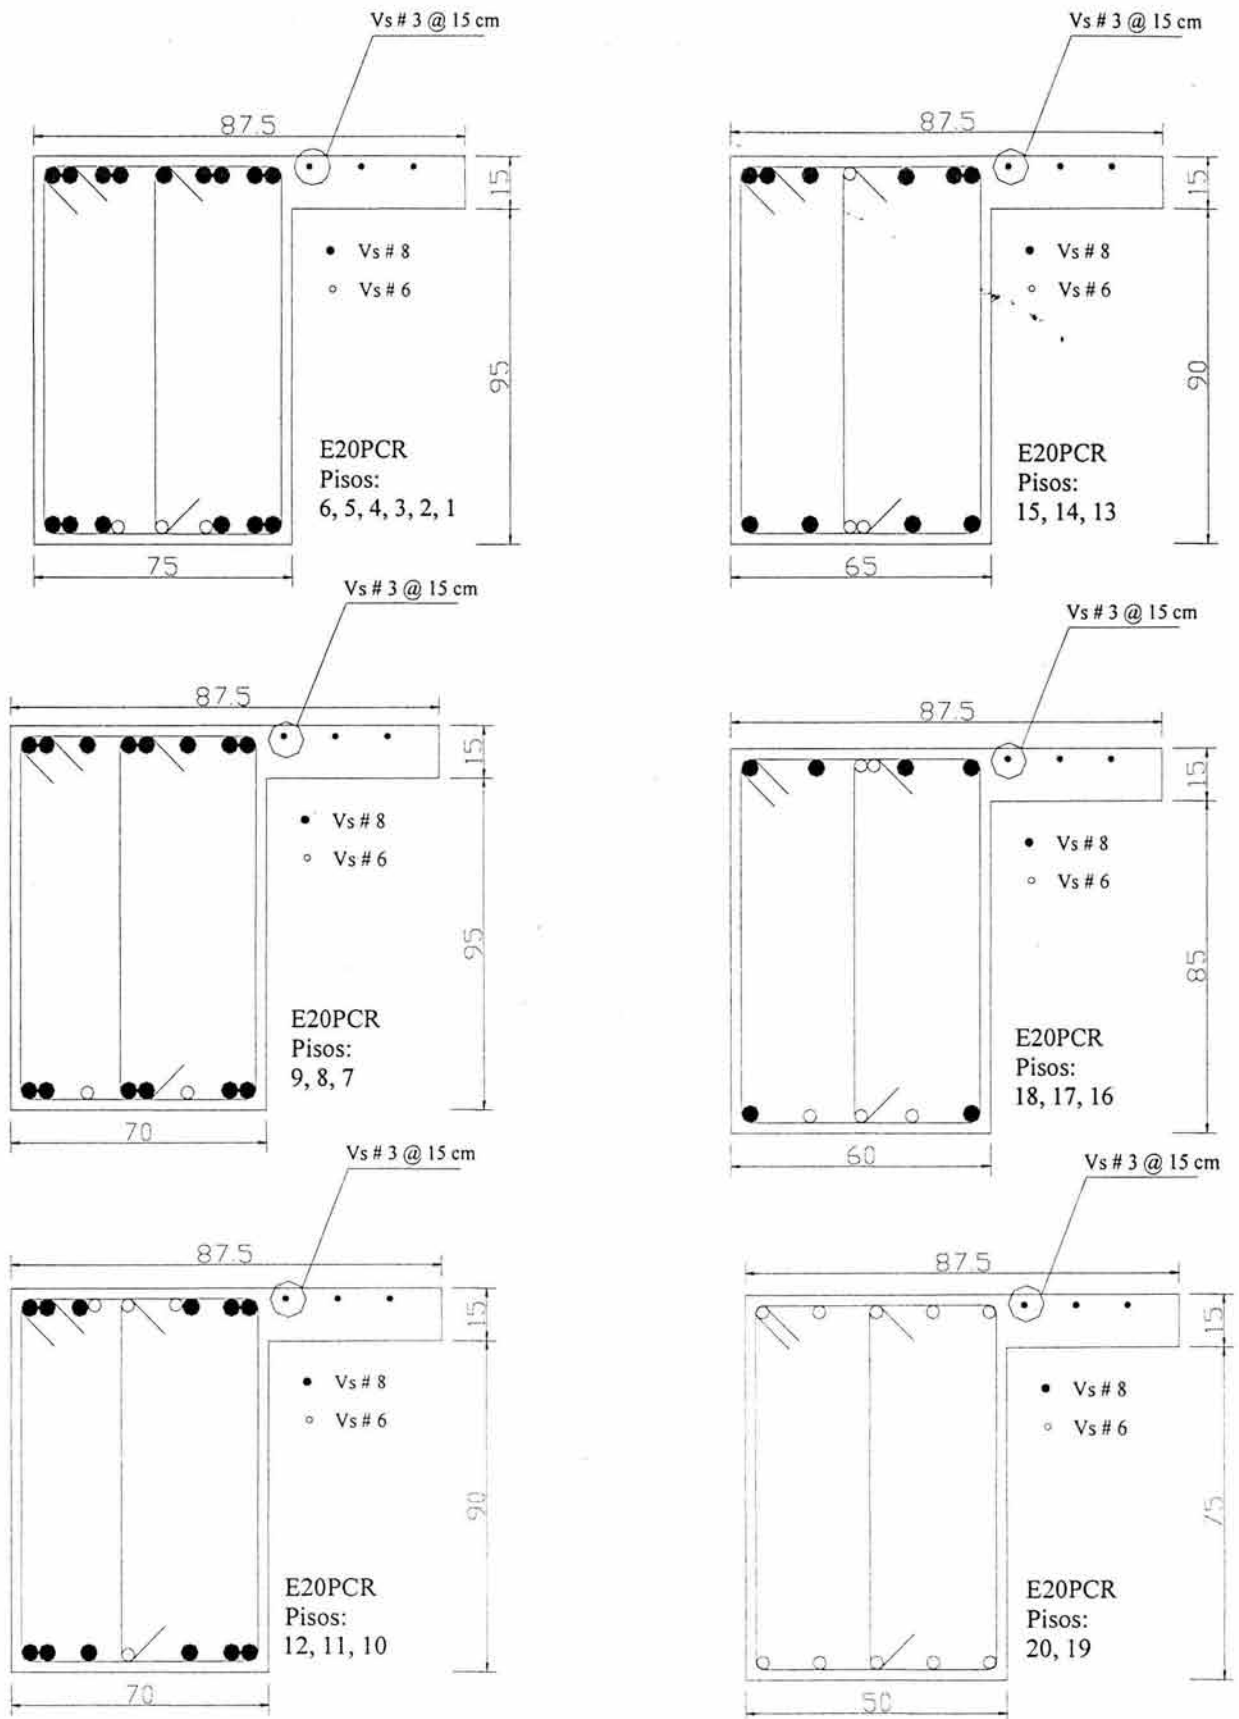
Detallado de vigas en edificio de 20 niveles (continuación).
